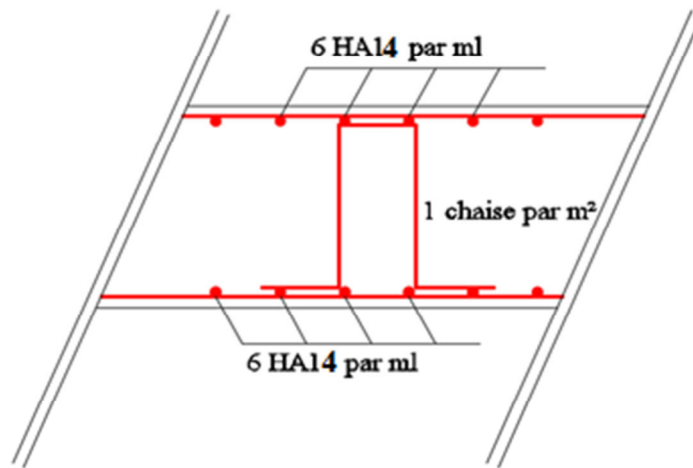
Schéma de ferrailage des poutres (nervure)
